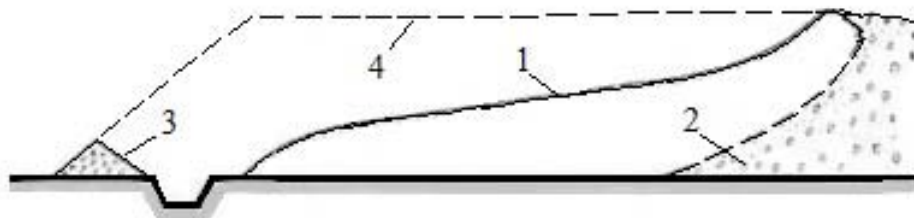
Устройство контрфорса из крепких твердых пород перед надподошвенным оползнем отвала [3]: 1 – поверхность оползающего отвала; 2 – поверхность скольжения; 3 – вал крепких пород; 4 – поверхность отвала после остановки оползня отвала
